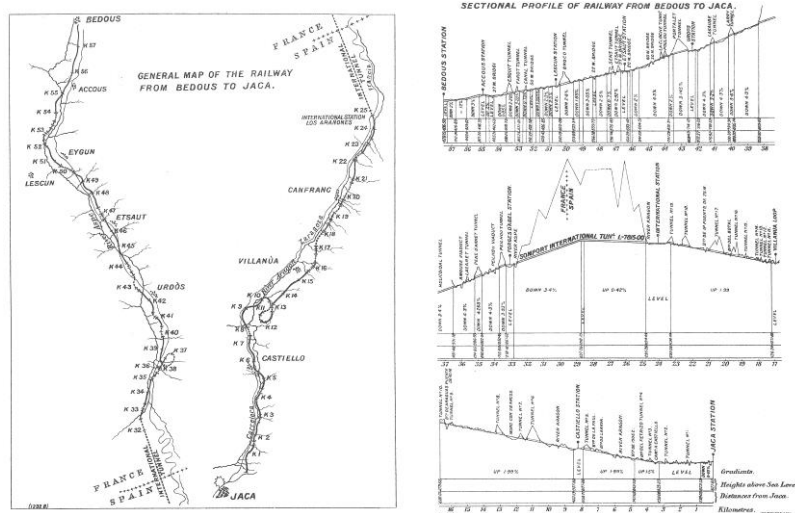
Diseño en planta y sección del Ferrocarril Transpirenaico. Fuente: (Rich, 1929).
